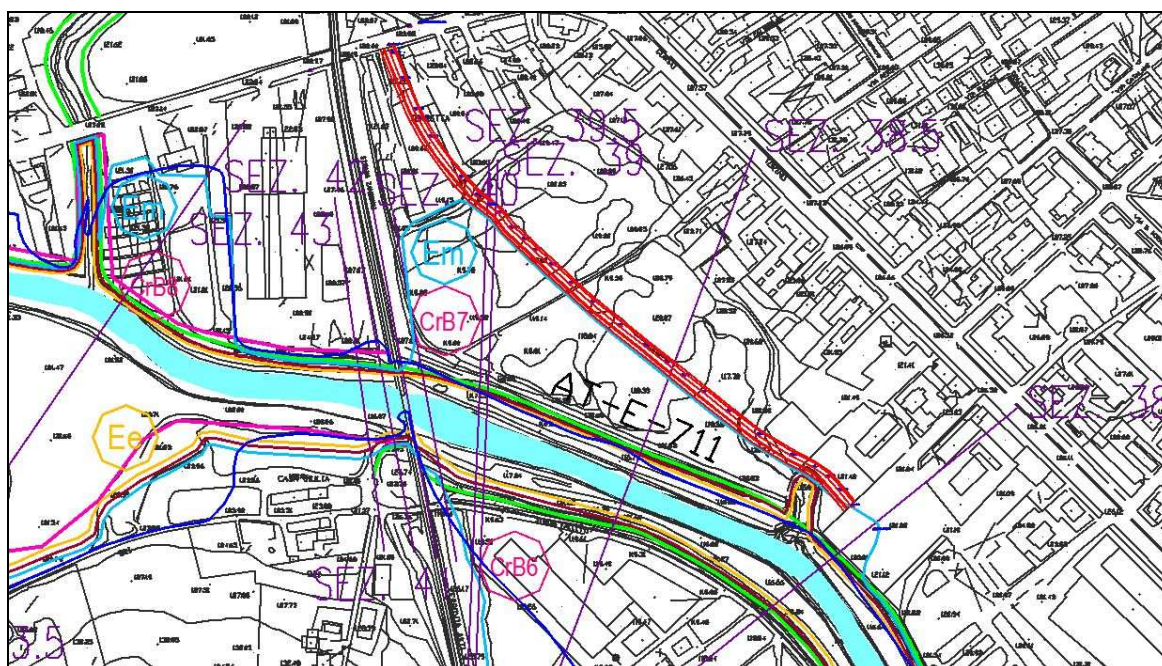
Planimetria (elab. 15.2.1) con ubicazione delle sezioni e dei punti critici (Arnaud, 2009).
